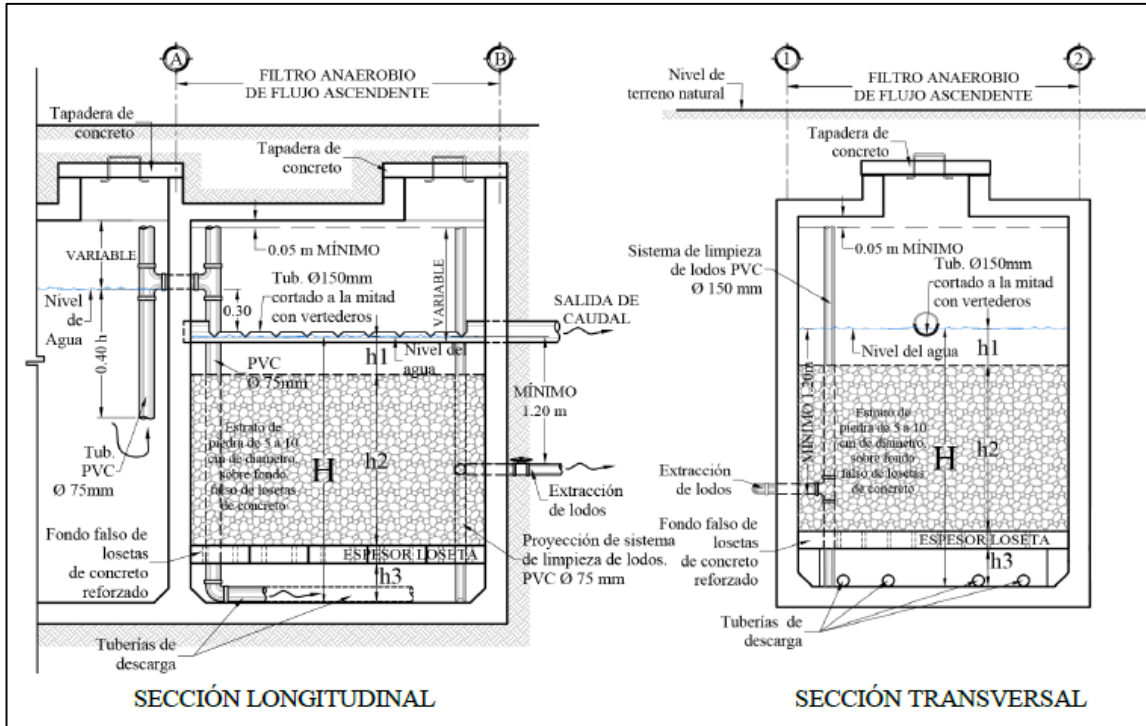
Detalles constructivos de un FAFA –Vista longitudinal y transversal
